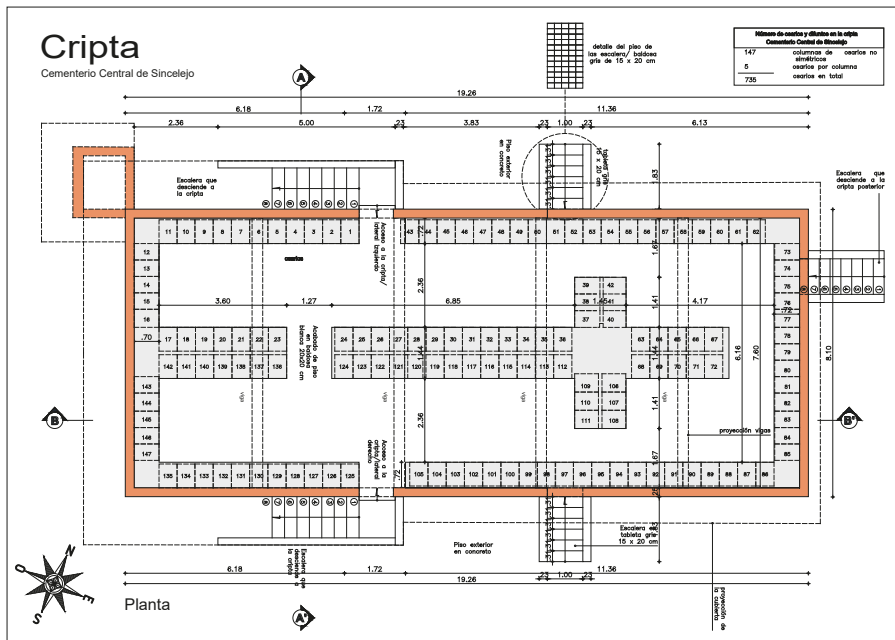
Planta cripta subterránea Cementerio Central de Sincelejo.
